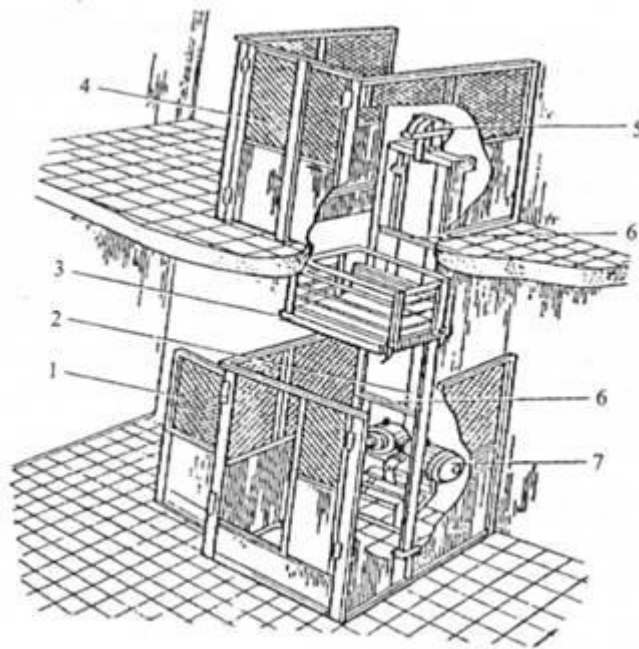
Похилий підйомник ПН-200: 1 _ нижня огорожа; 2 — ферма; 3 — платформа; 4 — верхня огорожа; 5 — блок; 6 — розкоси; 7 — привод
